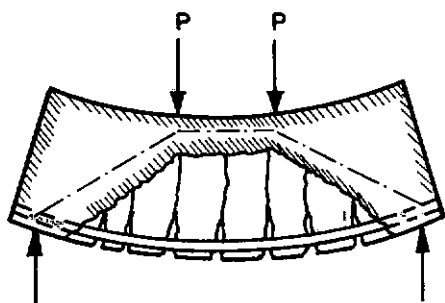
a - A viga se transforma em um arco de concreto bi-rotulado.
